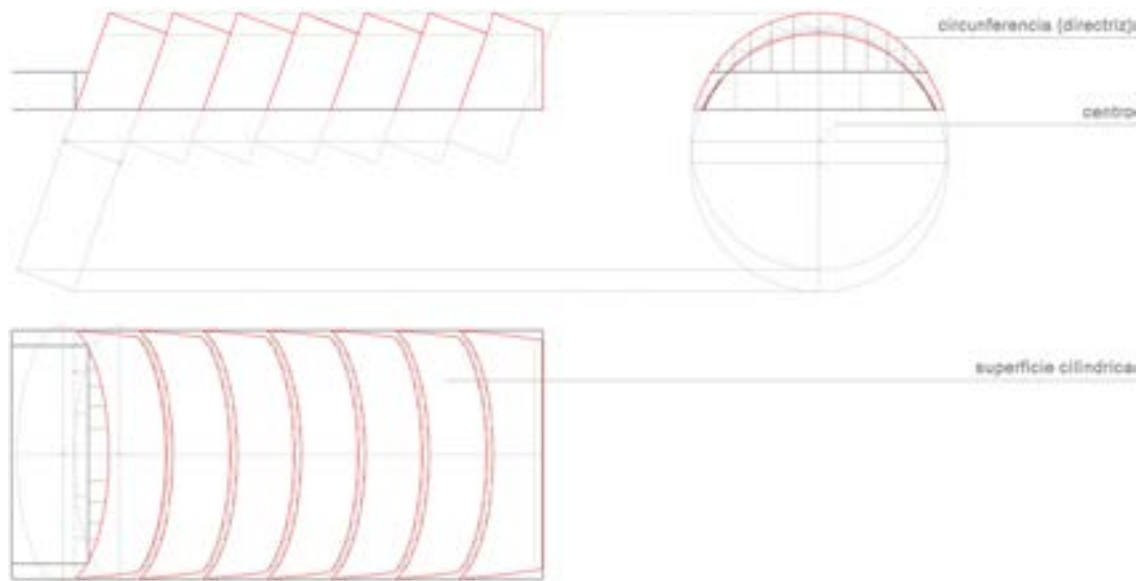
Esquema de planta y alzados de Nave industrial en Gossau, Heinz Hossdorf, 1956. Se puede apreciar que la superficie es un cilindro recto, con directriz en un plano inclinado. Dibujo de los autores.
